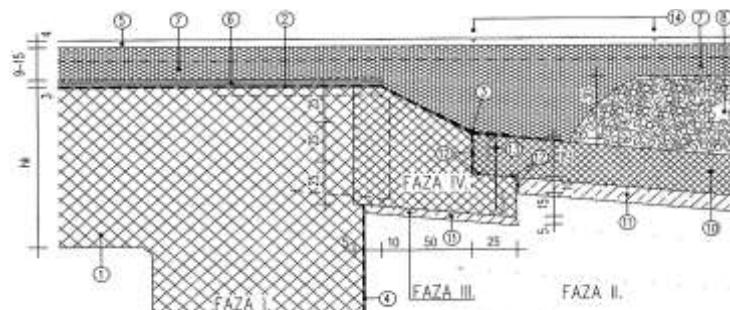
Detalj oslanjanja i vrha prelazne ploče kod grednih rasponskih AB konstrukcija kada je dužina rasponske konstrukcije veća od 150 m
